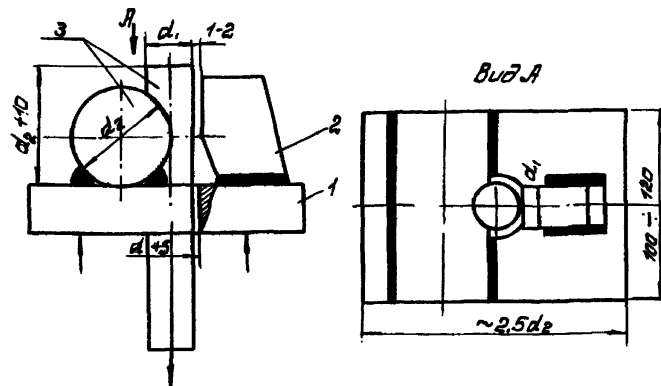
Схема испытаний на срез крестообразного соединения стержней крупных диаметров.
